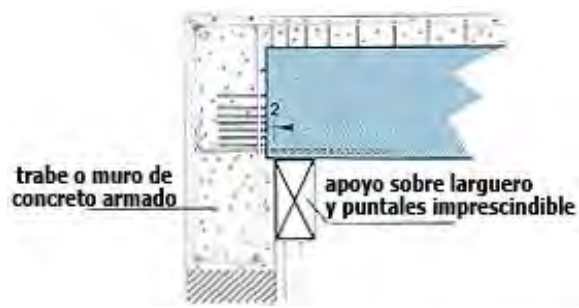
Apoyo sobre trabe de concreto armado o sobre muro de concreto armado con una entrega de sólo 2 cm que requiere apuntalamiento
